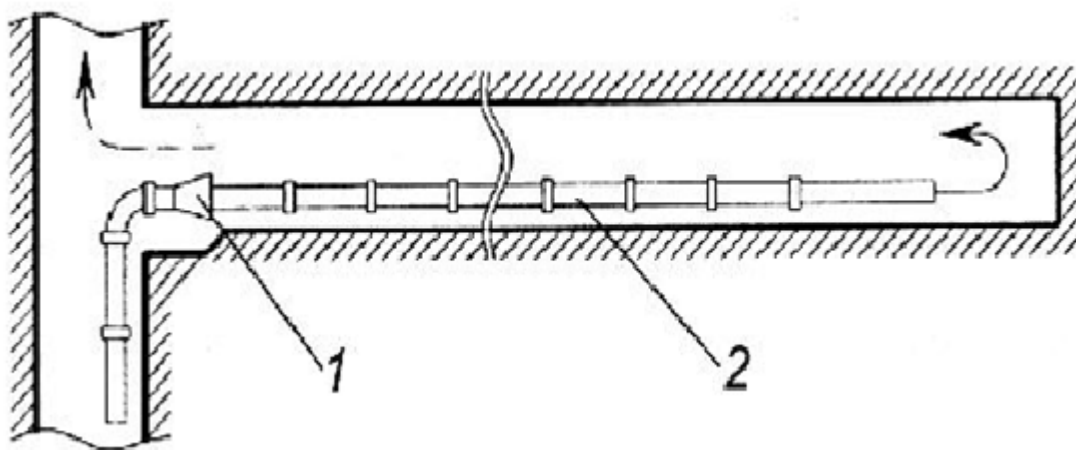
Схема нагнетательного проветривания тупиковой выработки: 1 – нагнетательный вентилятор; 2 – нагнетательный трубопровод.
